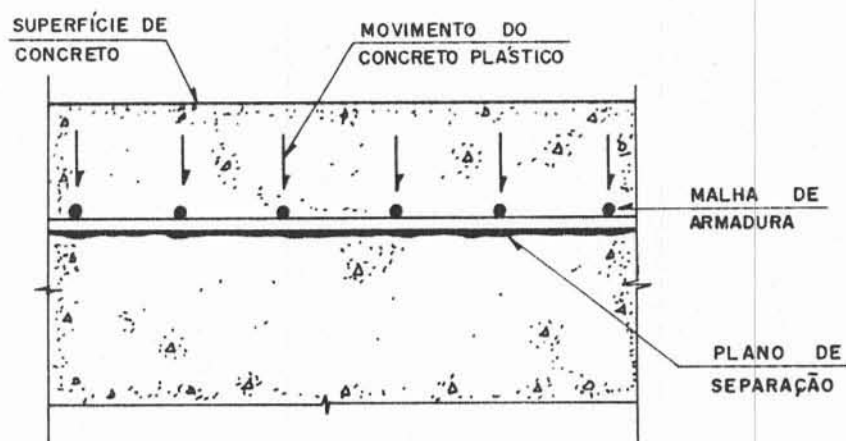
Plano de separação entre o concreto e a armadura causado pelo assentamento plástico (JOHNSON<sup>58</sup>)
